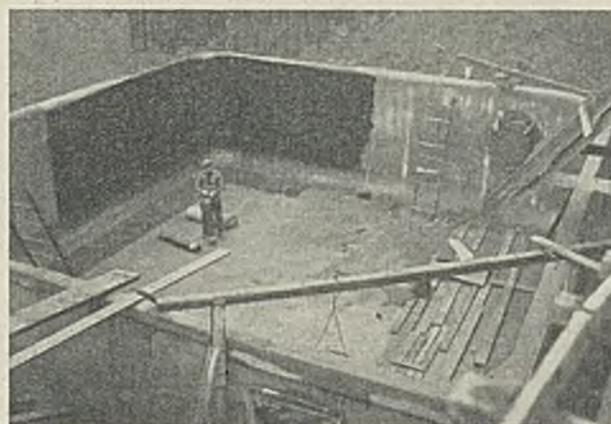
Unterer Teil der Schutzschicht des Schlammumpenhauses. Ankleben der Isolierschicht von innen. Rechts in der Wand ein Mantelrohr zur späteren Durchführung der Schlamm saugeleitung.
